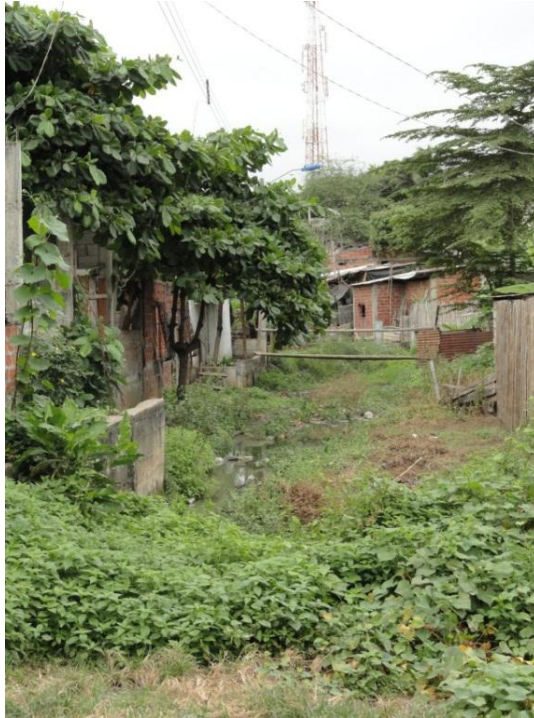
Cauce de drenaje que atraviesa la Mz. 405
